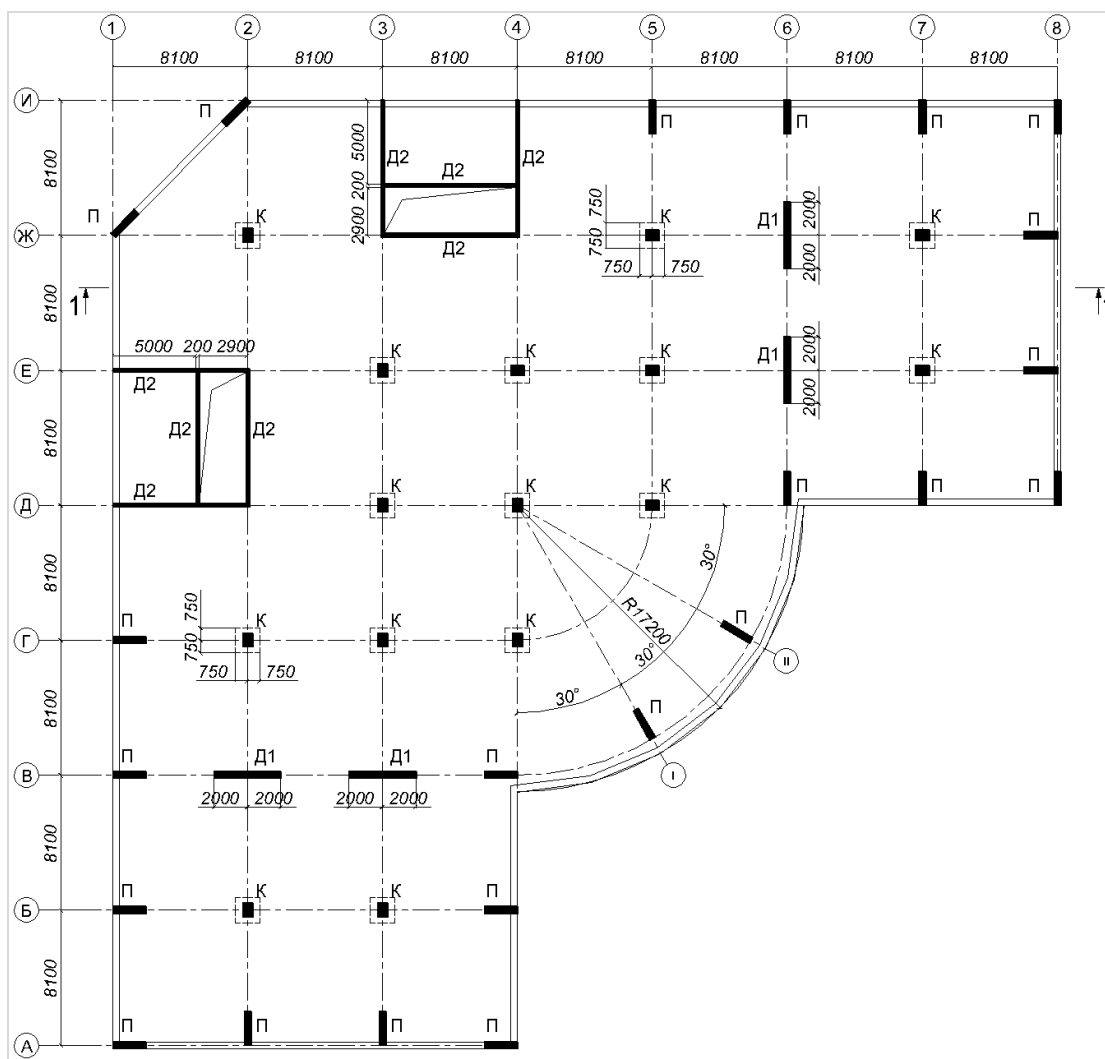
а План типового этажа на отметках от -3.300м до 9.900м
